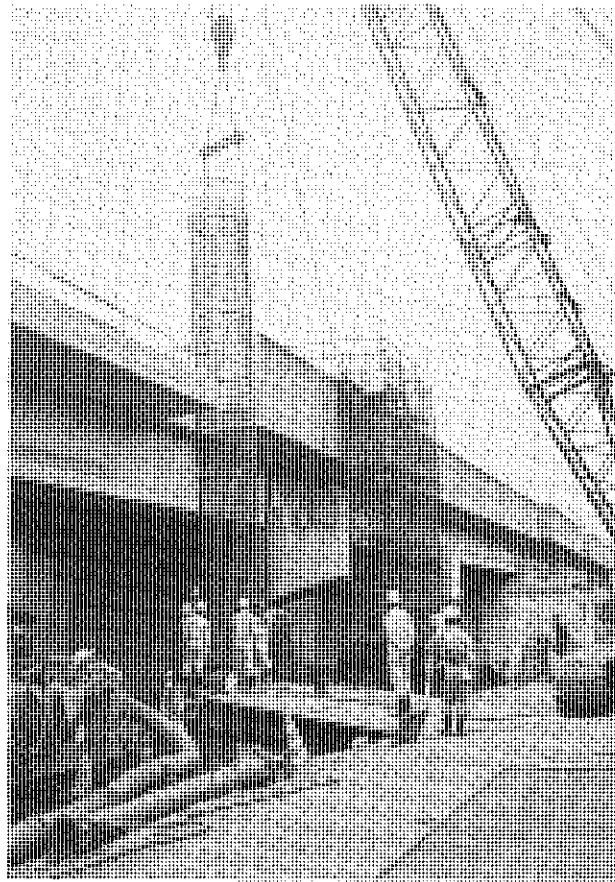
7 - 5 橋脚 P 1 基礎杭施工中
